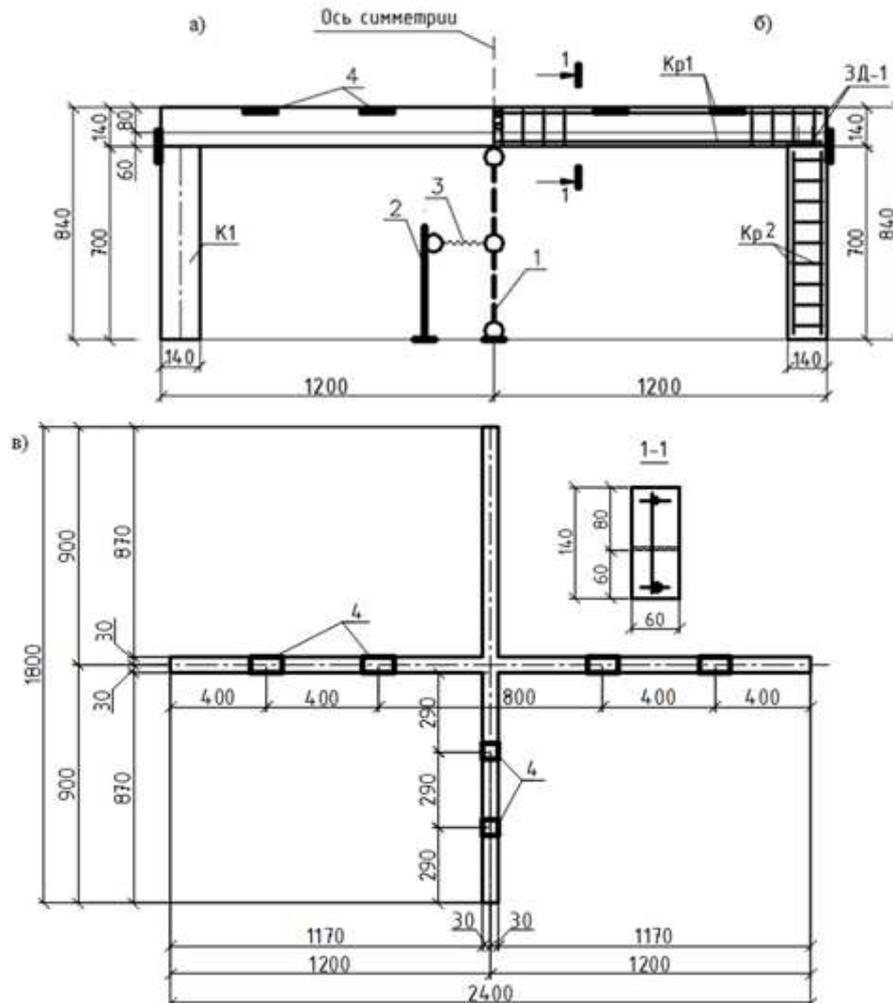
Конструкция опытного образца рамы: а – опалубочная схема; б – схема армирования; в – вид сверху: 1 – трехшарнирная выключаемая стойка; 2 – неподвижная стойка; 3 – горизонтальная связь; 4 – опорные пластины
